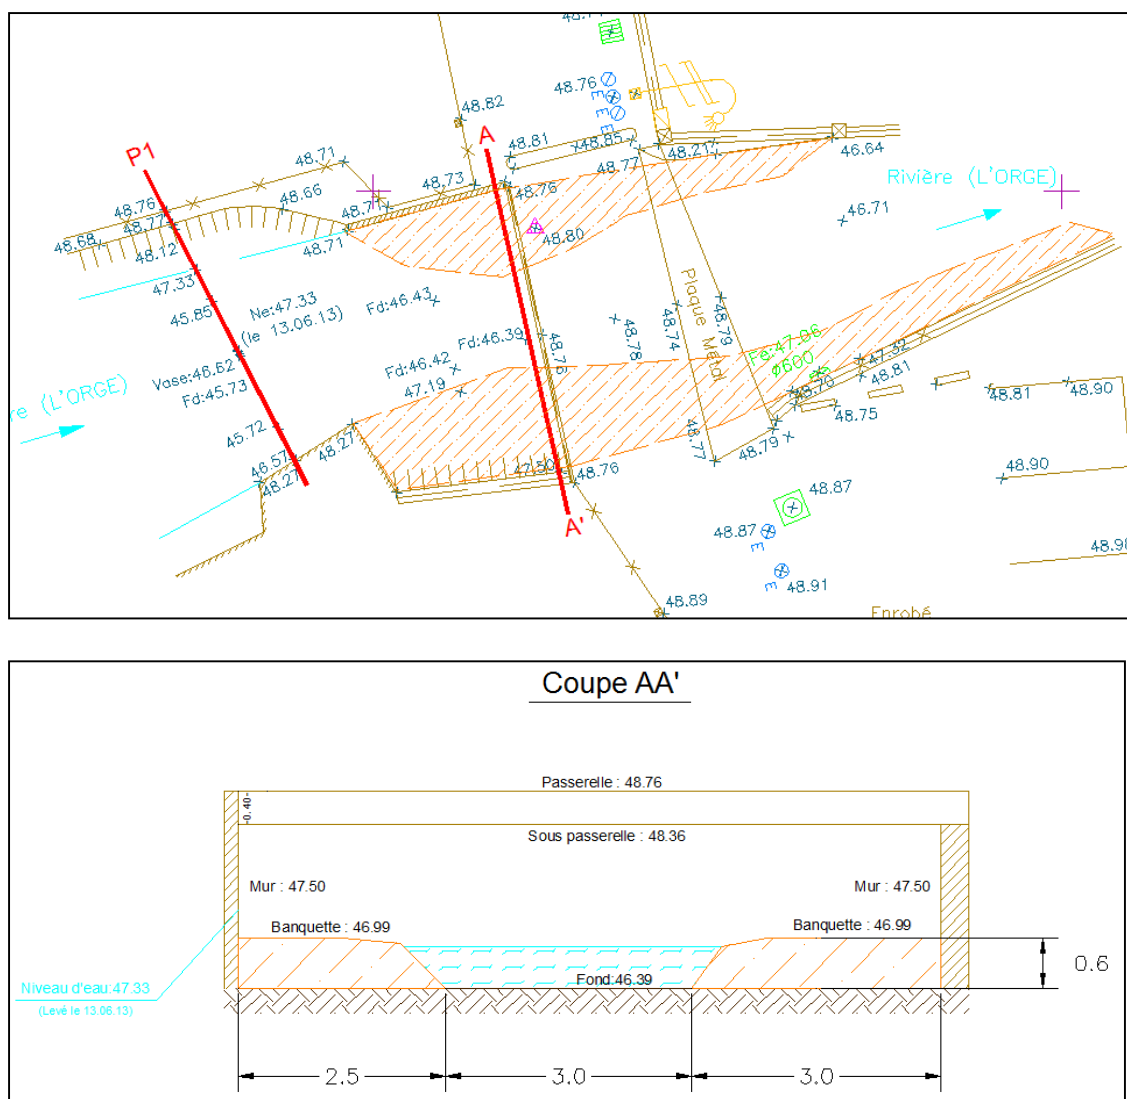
Plan de masse et coupe de l'ouvrage : état projet.
